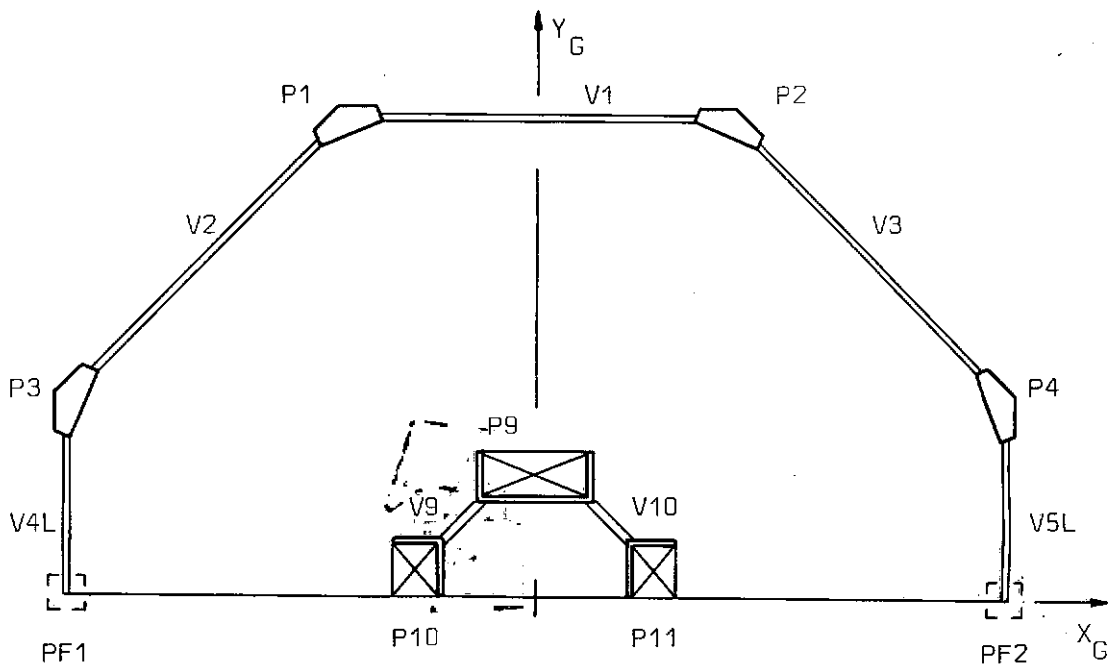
Esquema do pavimento tipo utilizado nos exemplos da série 2
